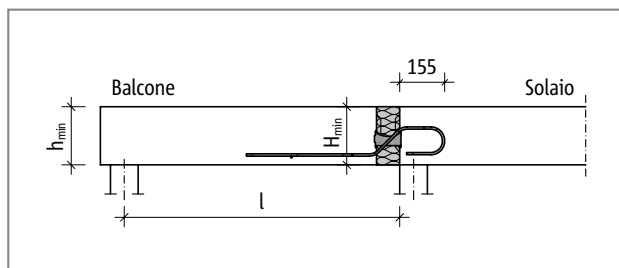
Schöck Isokorb® tipo Q10S - Q30S: schema statico
